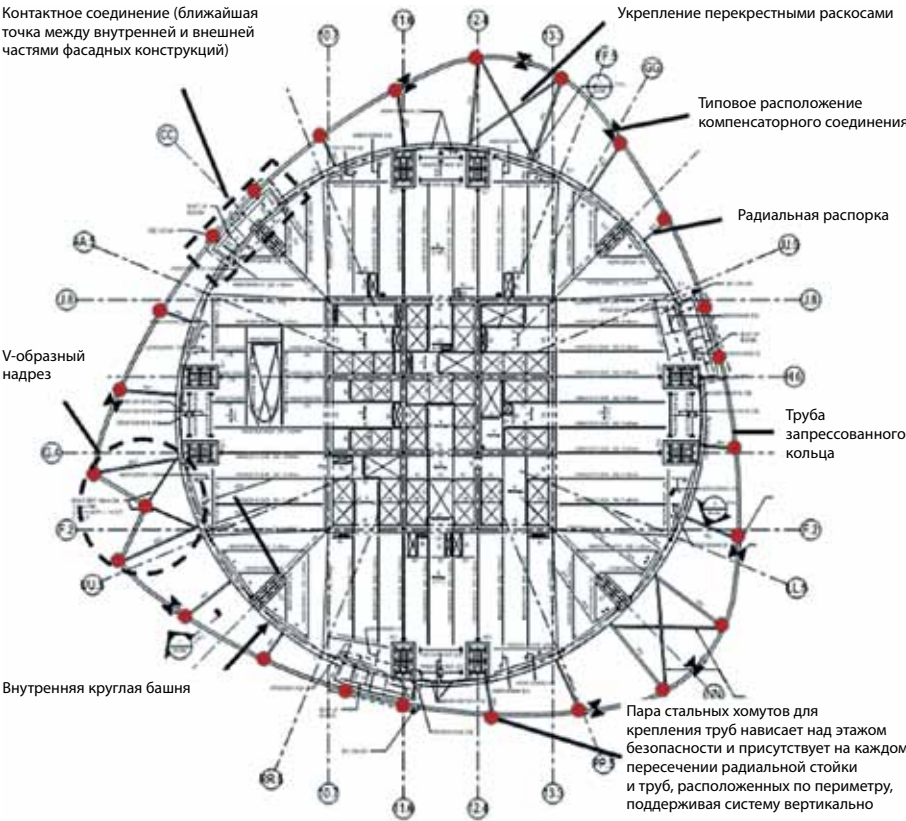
Shanghai Tower. Схема показывает плиты перекрытия, встроенные стальные элементы в колонках, подвесной фасад поддерживает система труб. © Thornton Tomasetti
